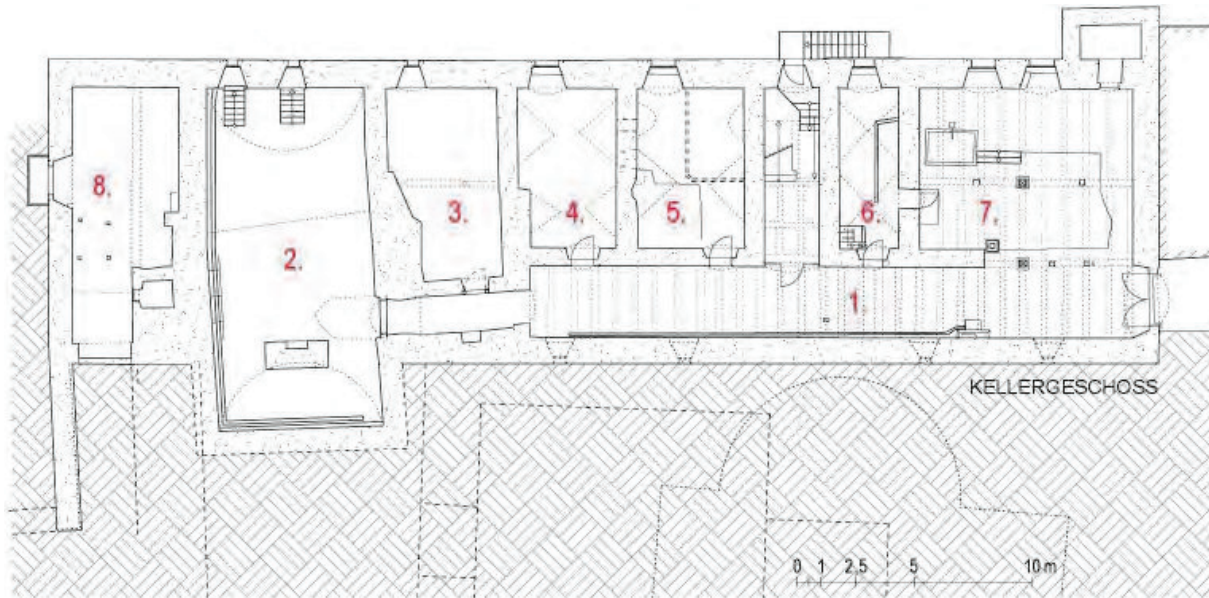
Aktueller Grundriss des Kellergeschosses mit Benennung von Raumnutzungen zur Klosterzeit: (1) Keller gang, (2) Großer Keller, (3) Kleiner Keller, (4) Gesindestube, (5) Backküche, (6) sogenanntes Bädle, (7) Waschküche, (8) Zugang zum Klostertor (Grundriss: Timo Raible 2018).
